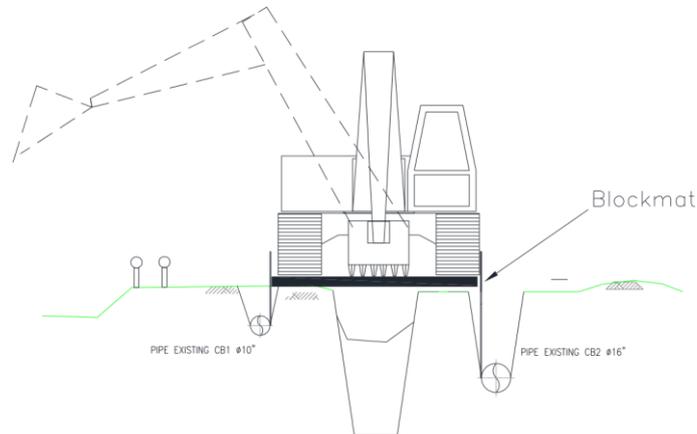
Pemasangan Protect untuk Pipa Eksisting
